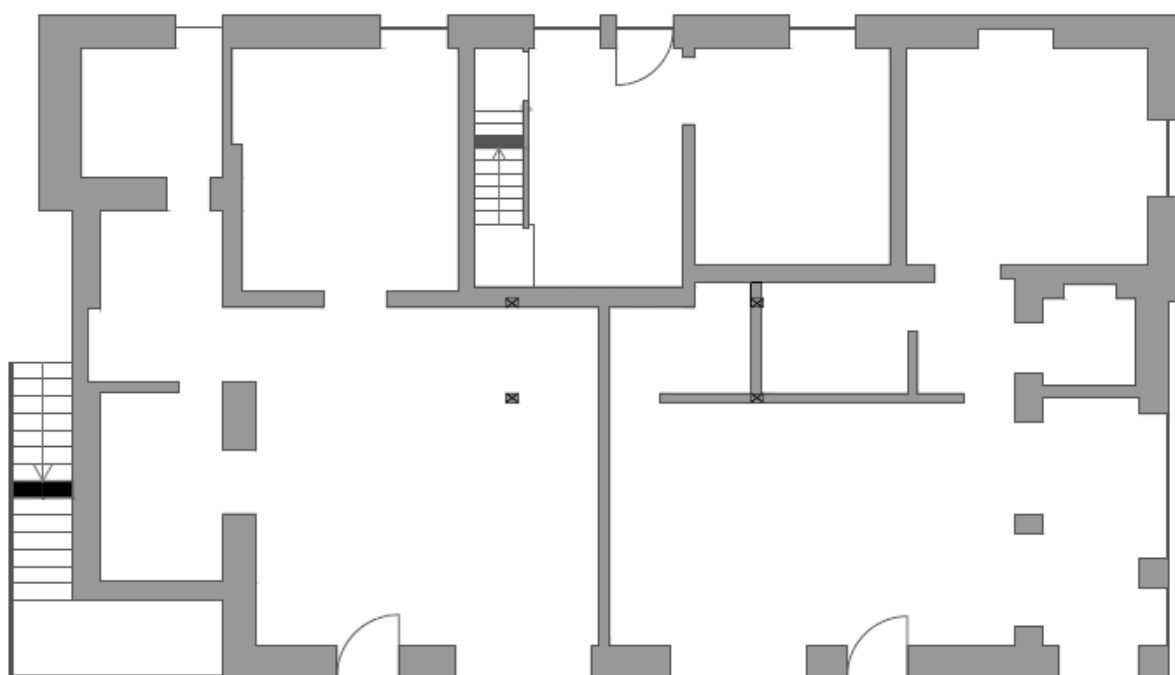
Planta atual da Casa de Santo António. Piso térreo
